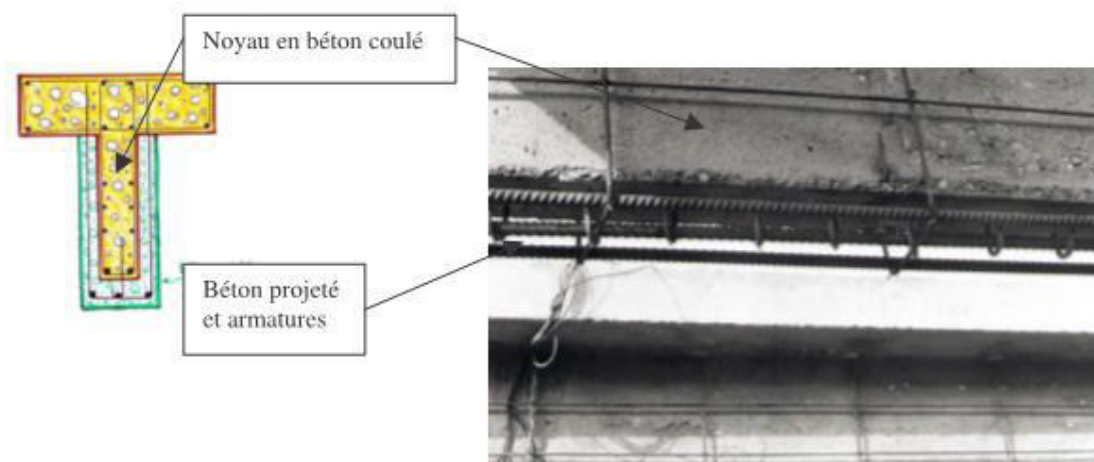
Renforcement d'une poutre au moyen de béton projeté
